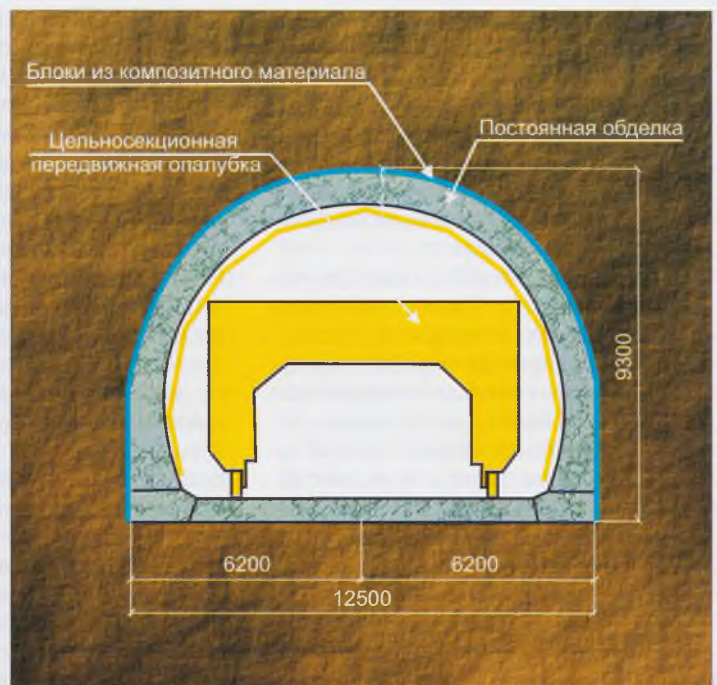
Бетонирование тоннеля с композитными блоками в качестве гидроизоляции
